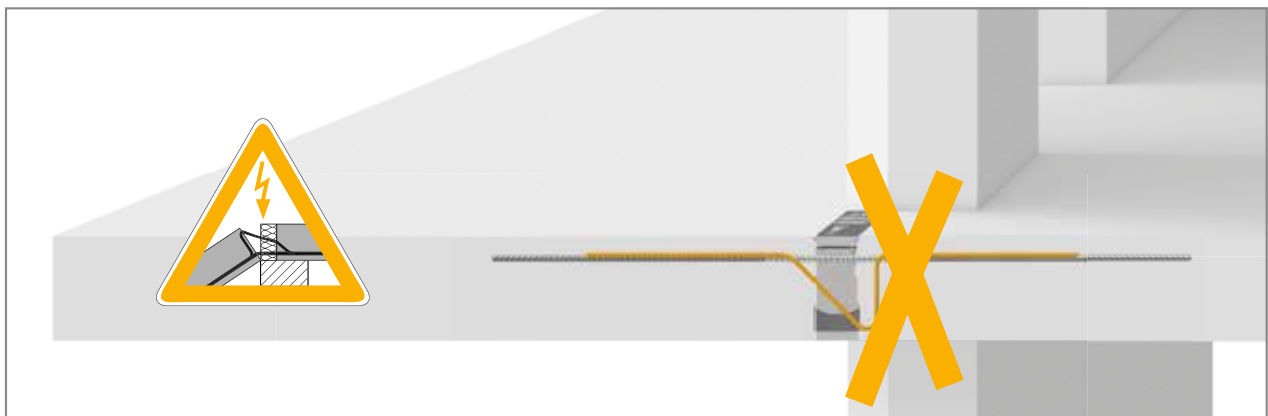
Schöck Isokorb® tip K: prenašanje prečne sile
